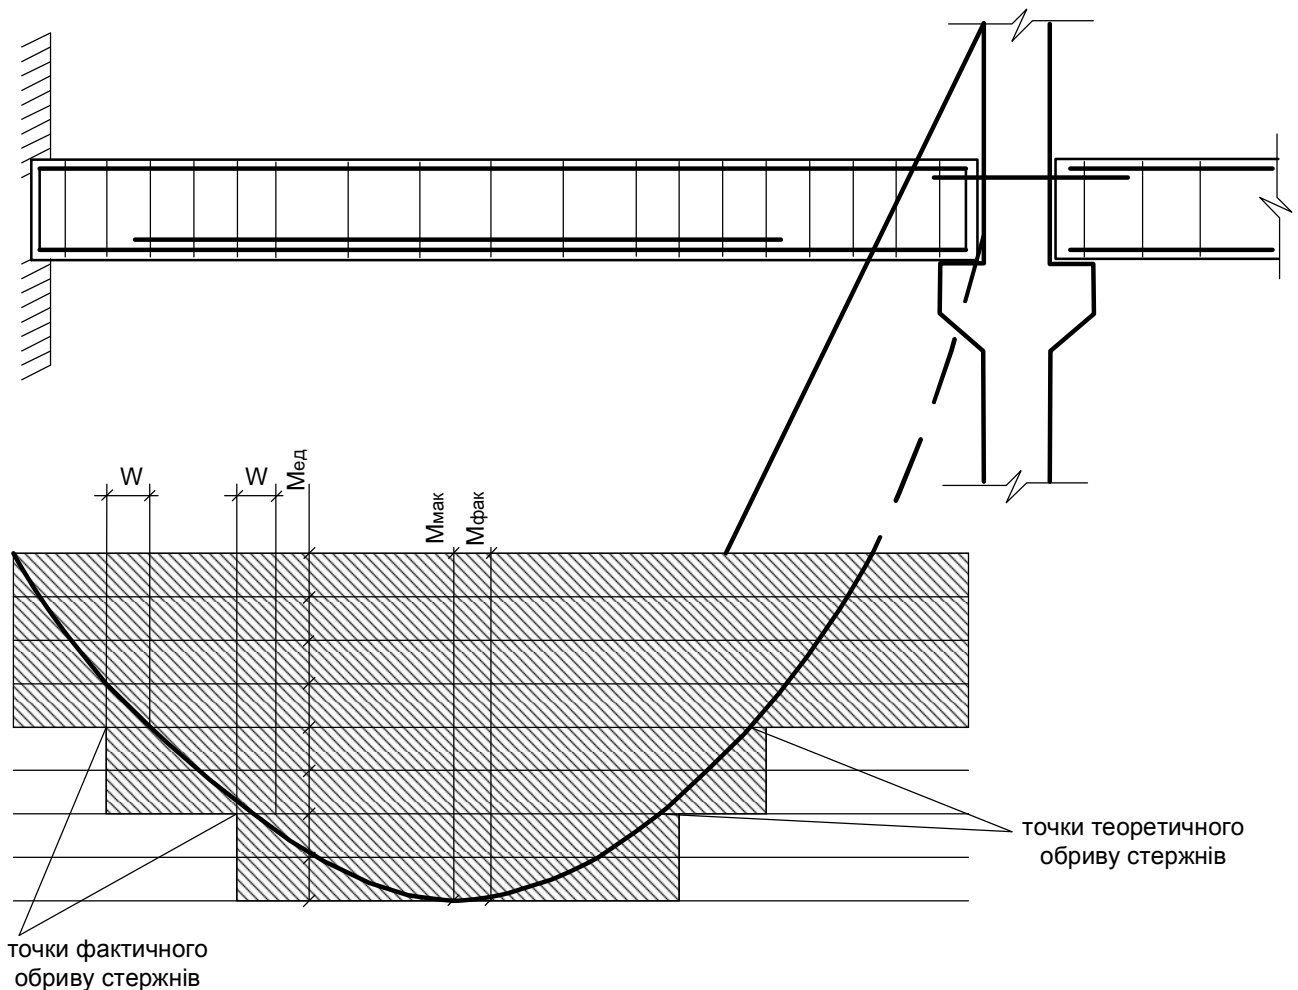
Епюра матеріалів для нижньої (прольотної) поздовжньої робочої арматури
